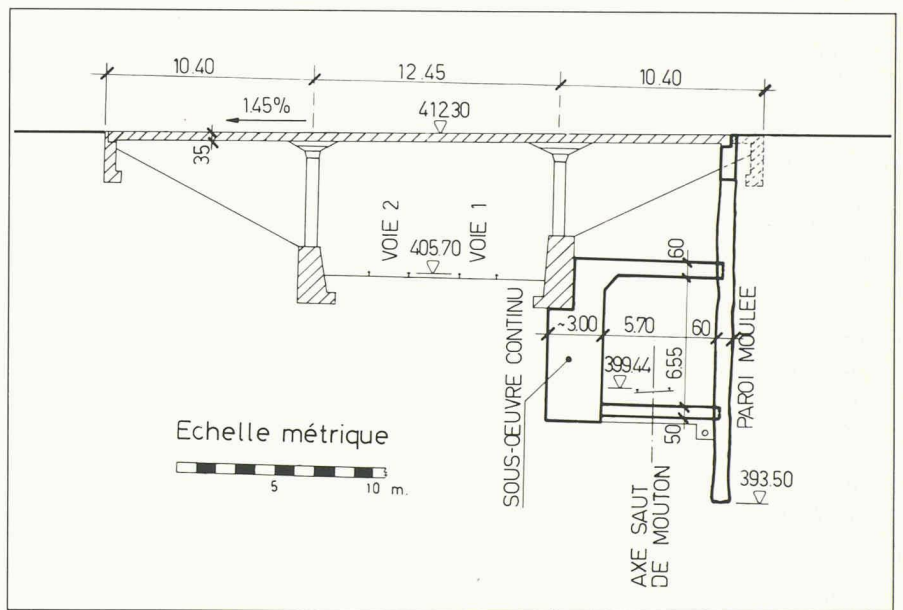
Coupe type au droit de l'avenue Gallatin.
